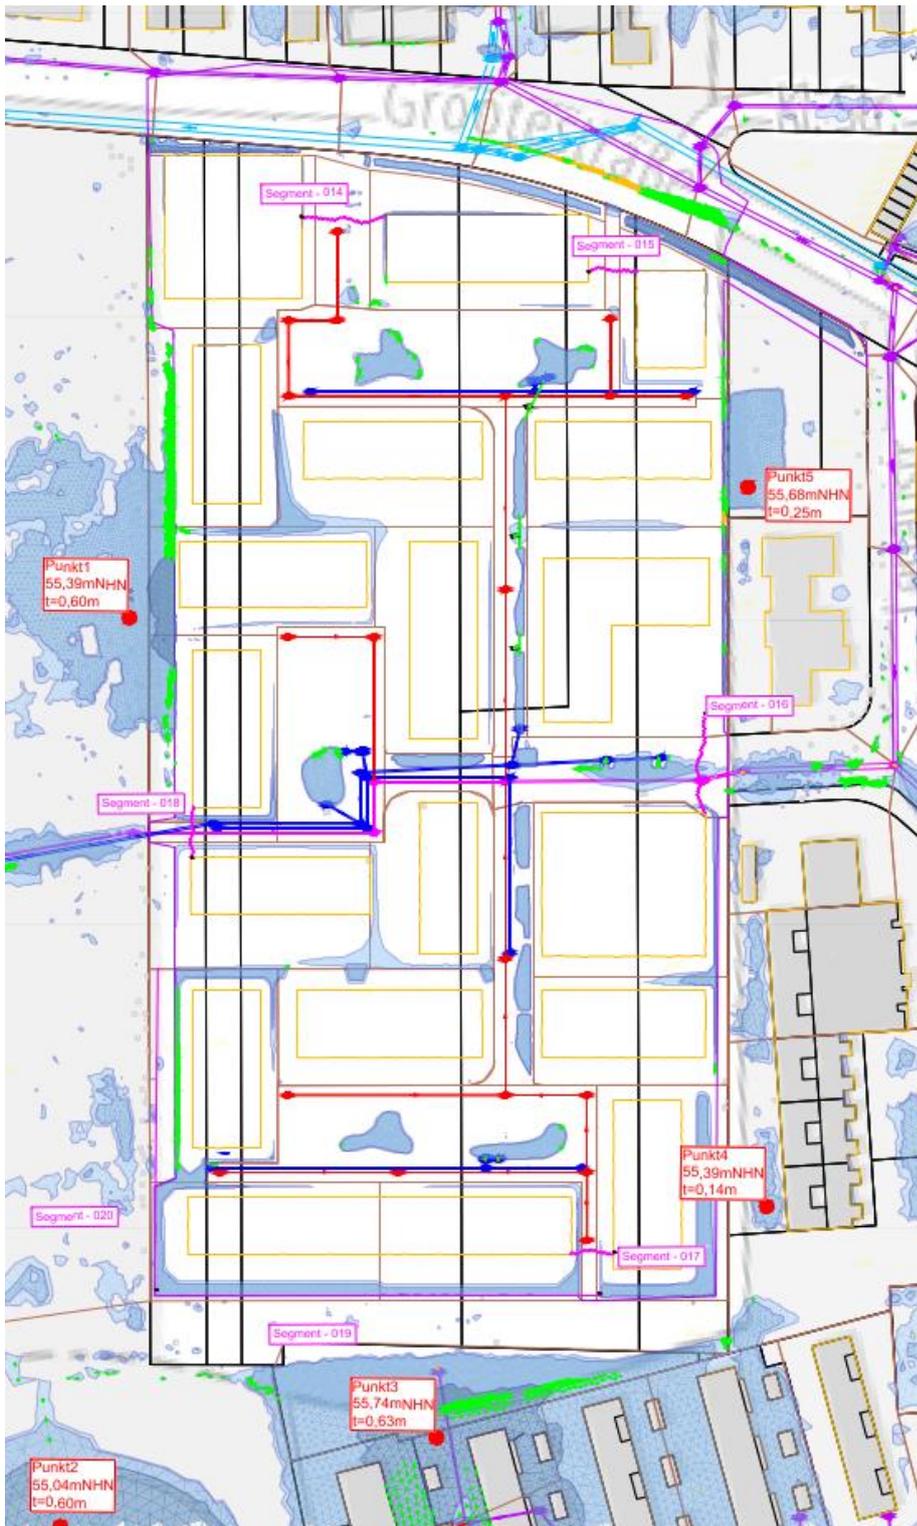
Ausschnitt Überflutungsbetrachtung Lageplan 321-sk_EP_403_LP
